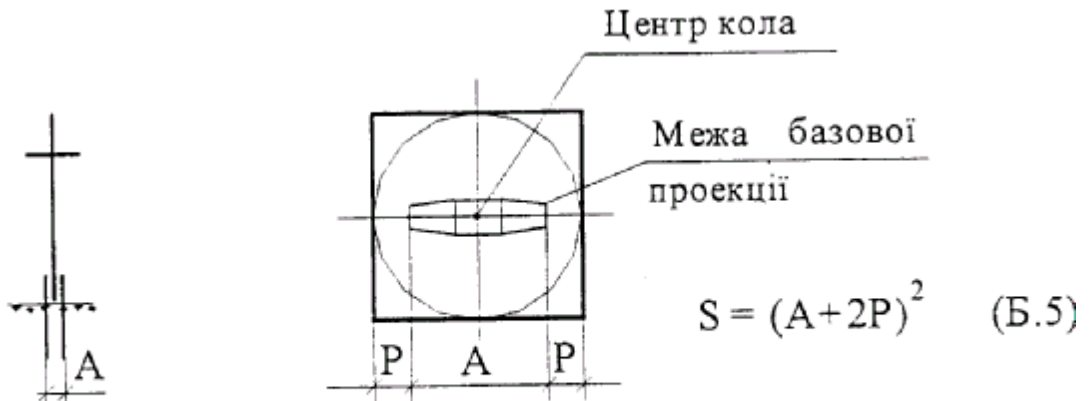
Стояк одиночний з круглим перерізом з ригельним закріпленням у ґрунті при довжині ригеля понад 1 м
